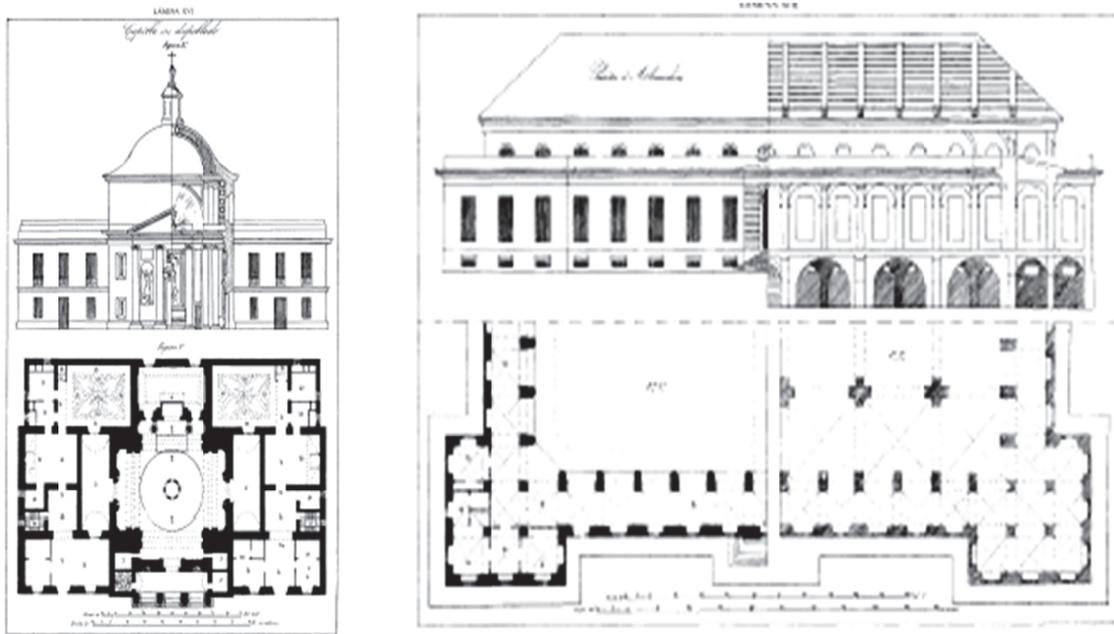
Planta y sección de un edificio urbano de tipo público según Fornés y Gurrea.
